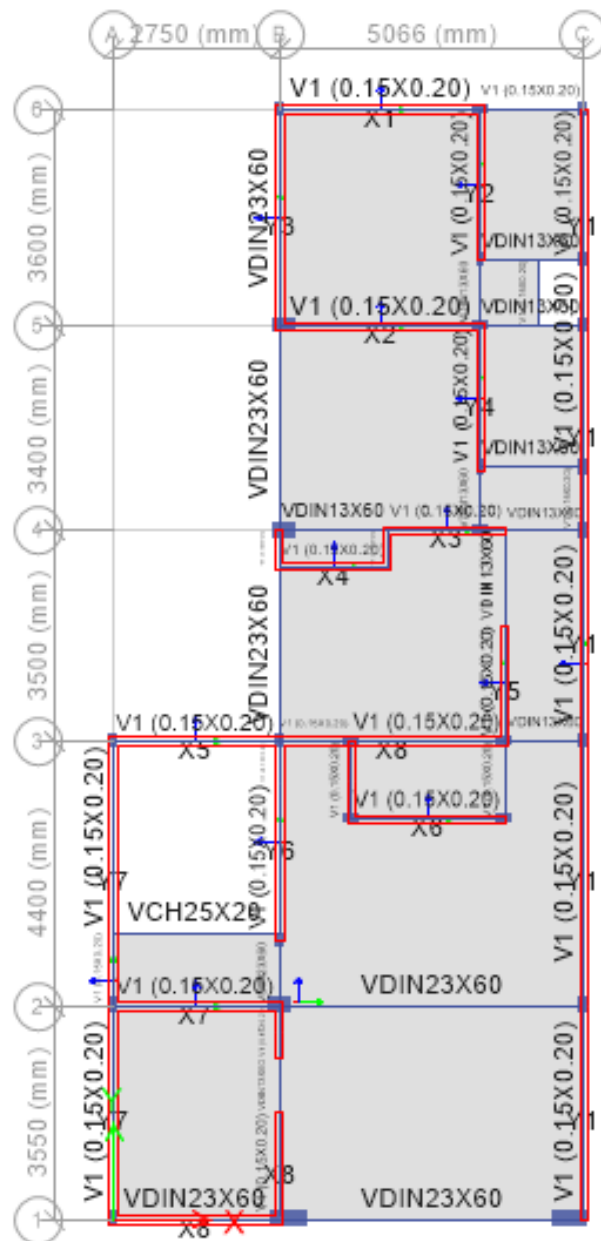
Distribución de la planta típica de la edificación con muros estructurales a base de King Kong 18 huecos
